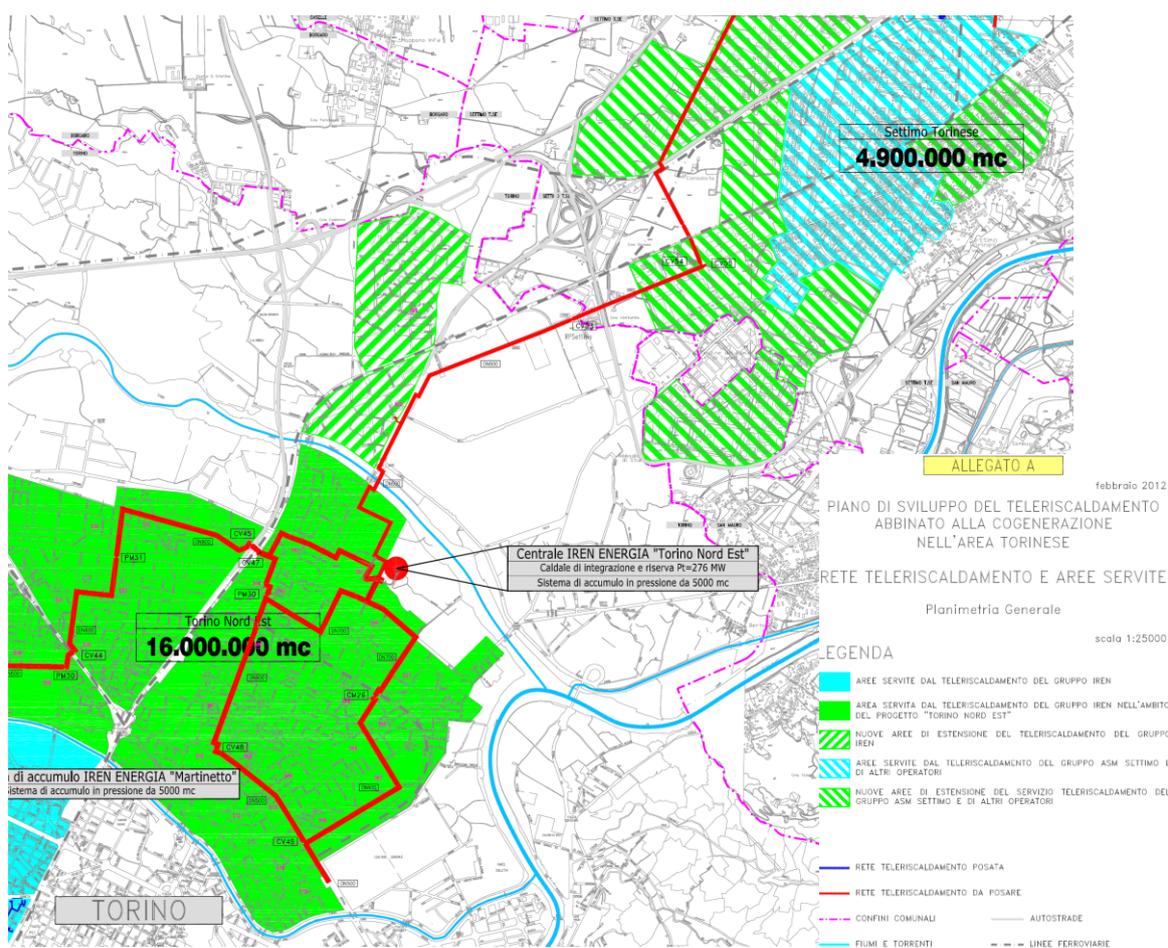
Planimetria generale, rete di teleriscaldamento e aree servite e interventi di sviluppo
